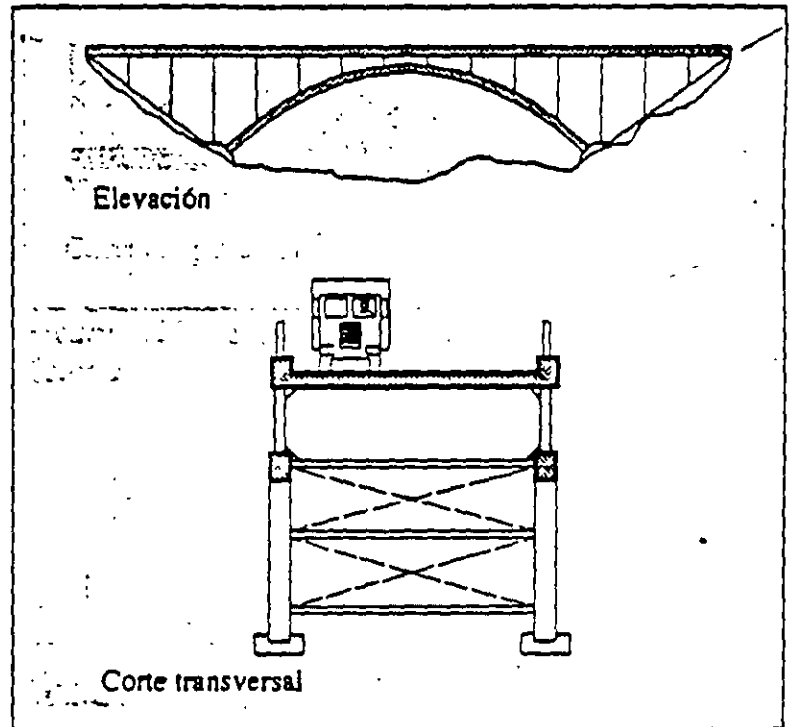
Sección transversal, tipo 51, Arco Inferior, tipo abierto
